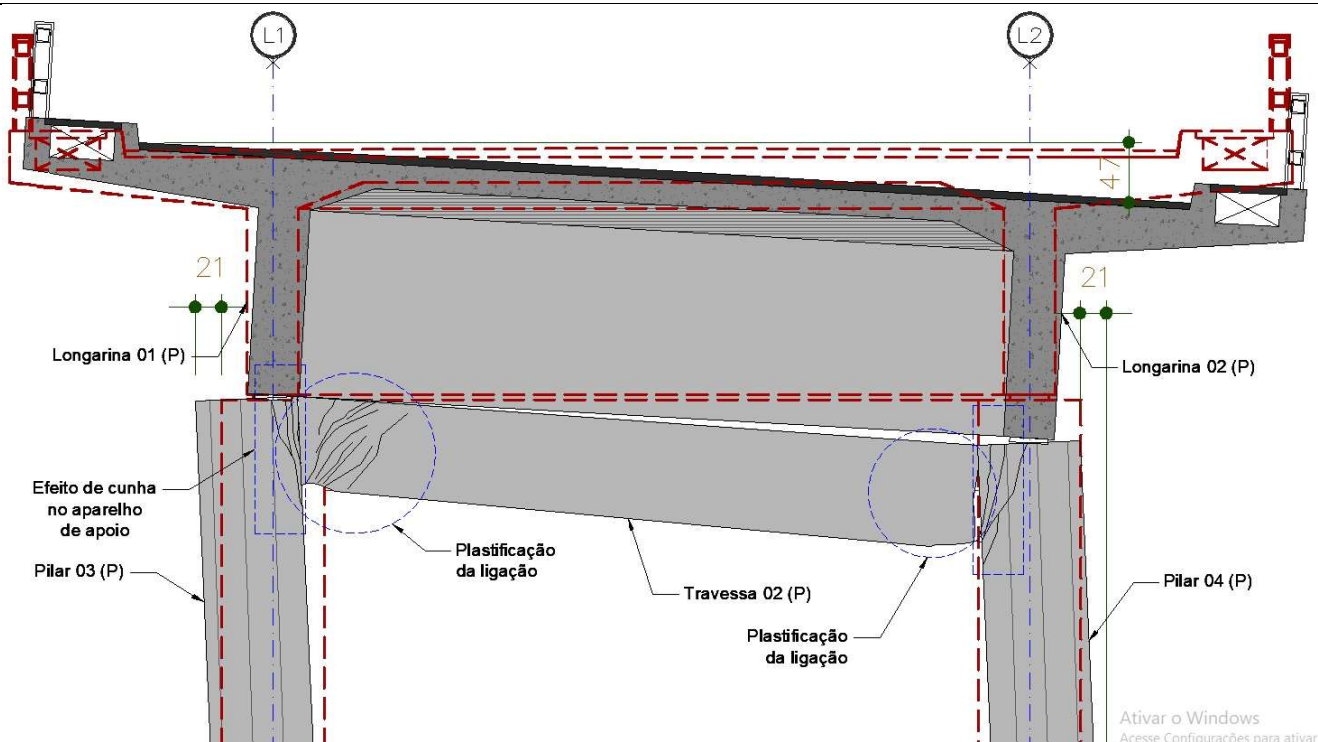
croqui esquemático demonstrando as condições estruturais do pórtico 2.
